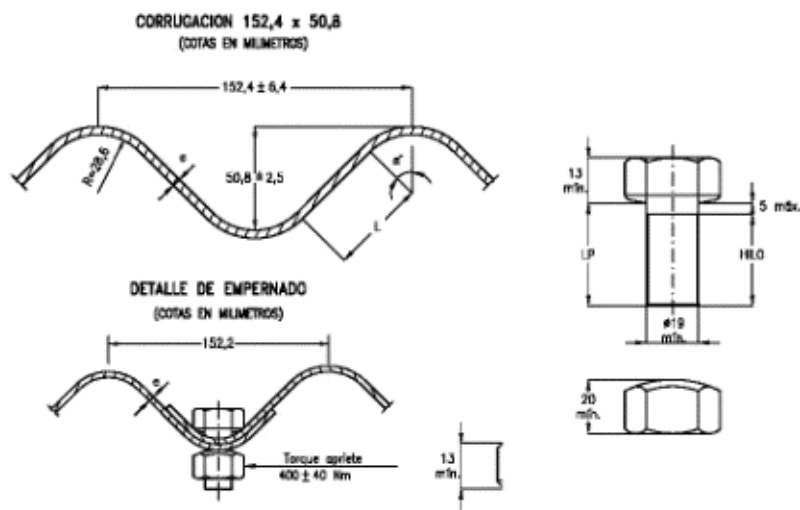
Detalles de corrugación 152,4 x 50,8 y de empernado.
